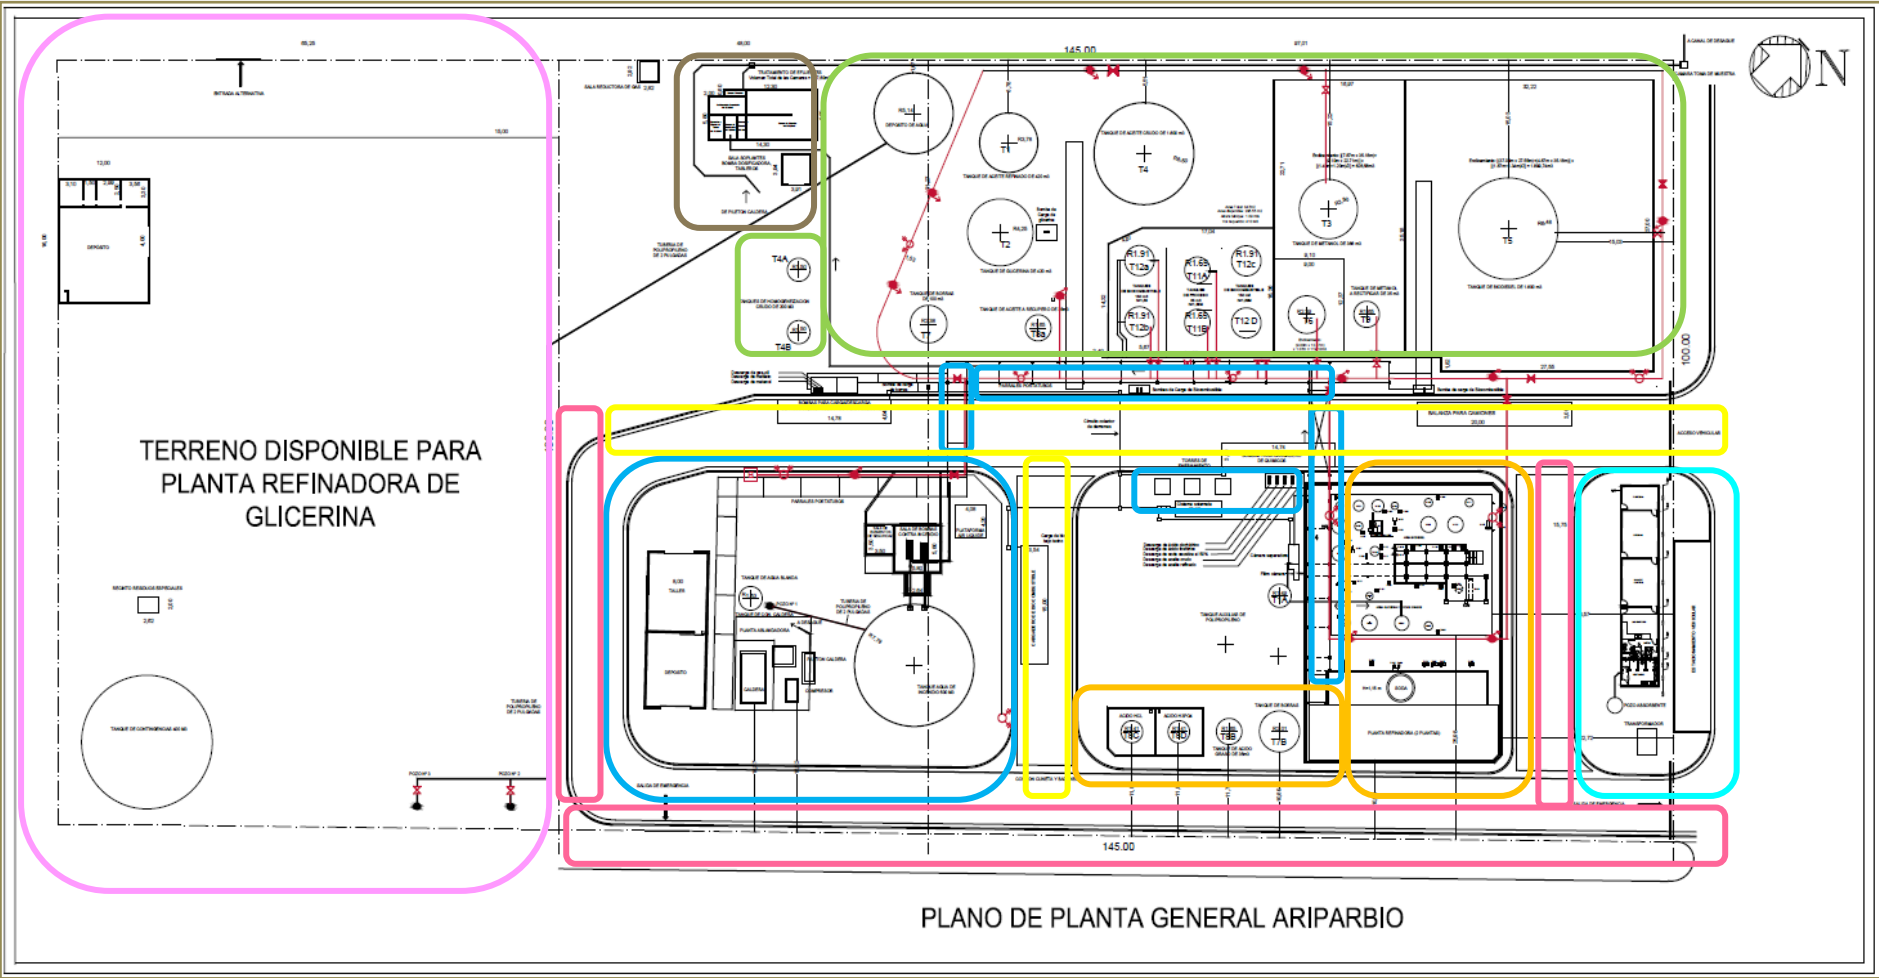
Emplazamiento actual de AriparBio y detalle de zona disponible para planta refinadora de glicerina.
